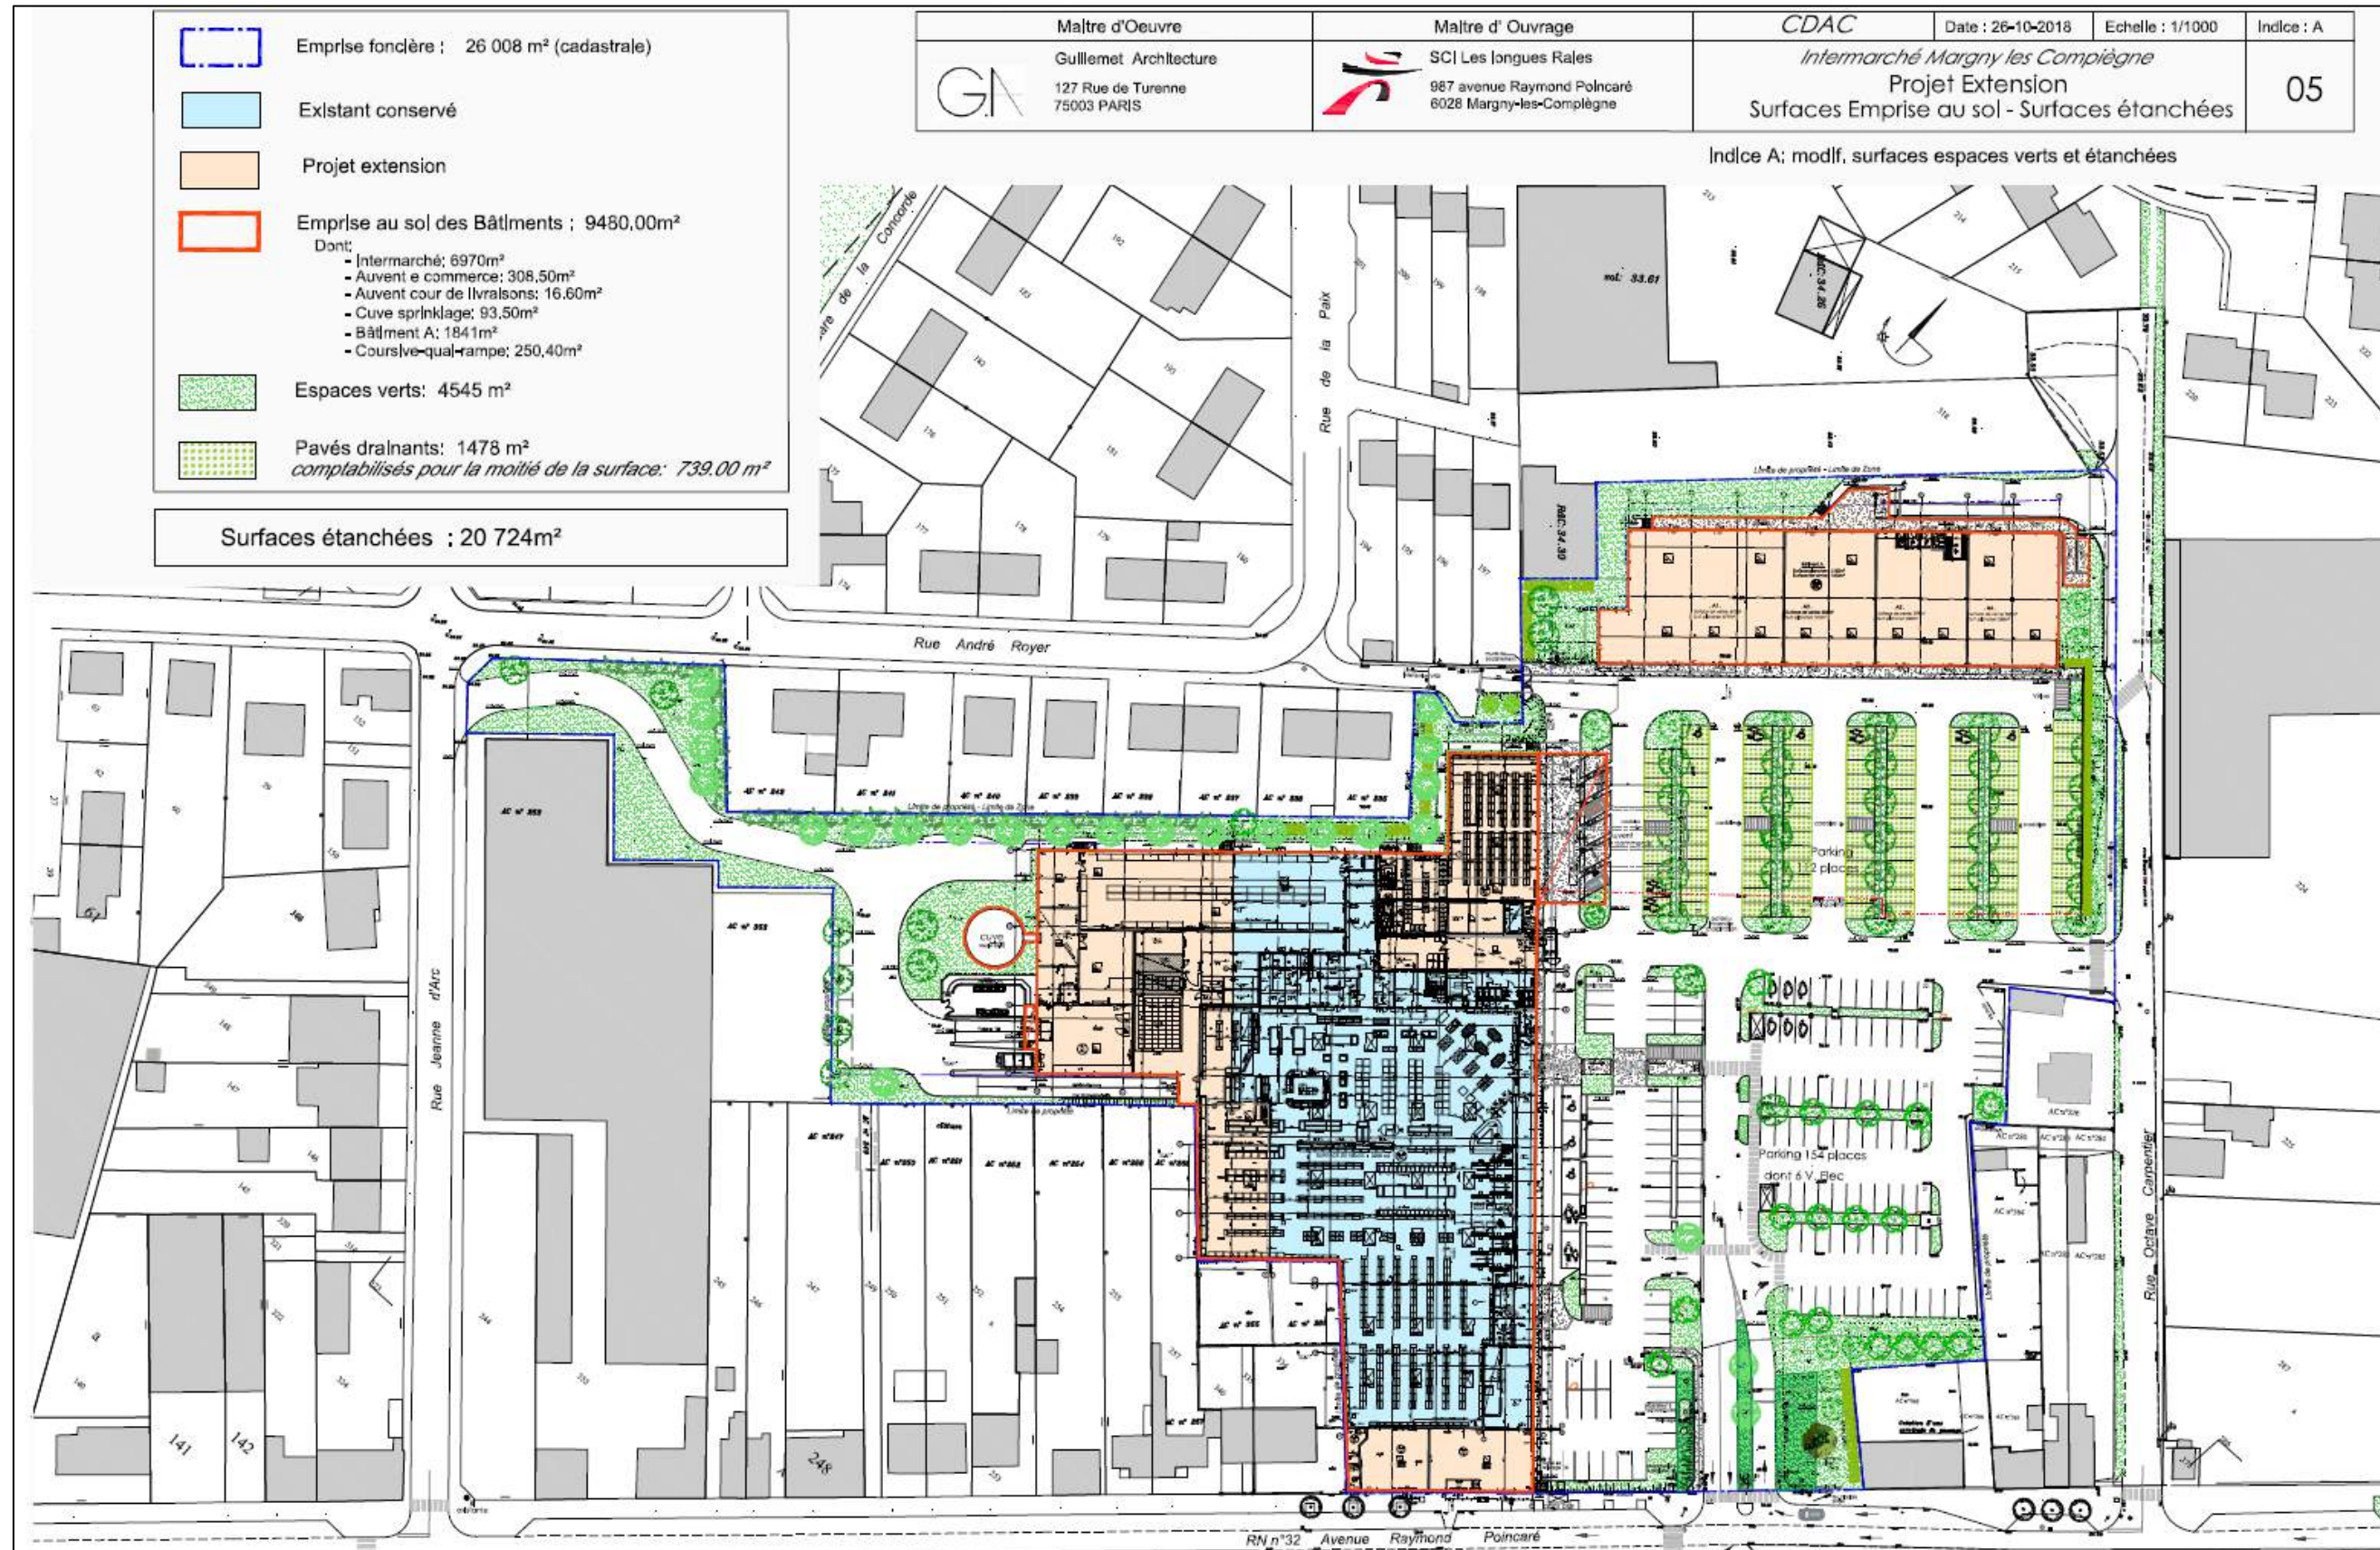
Plan du projet d'extension (Source : Permis de Construire)
